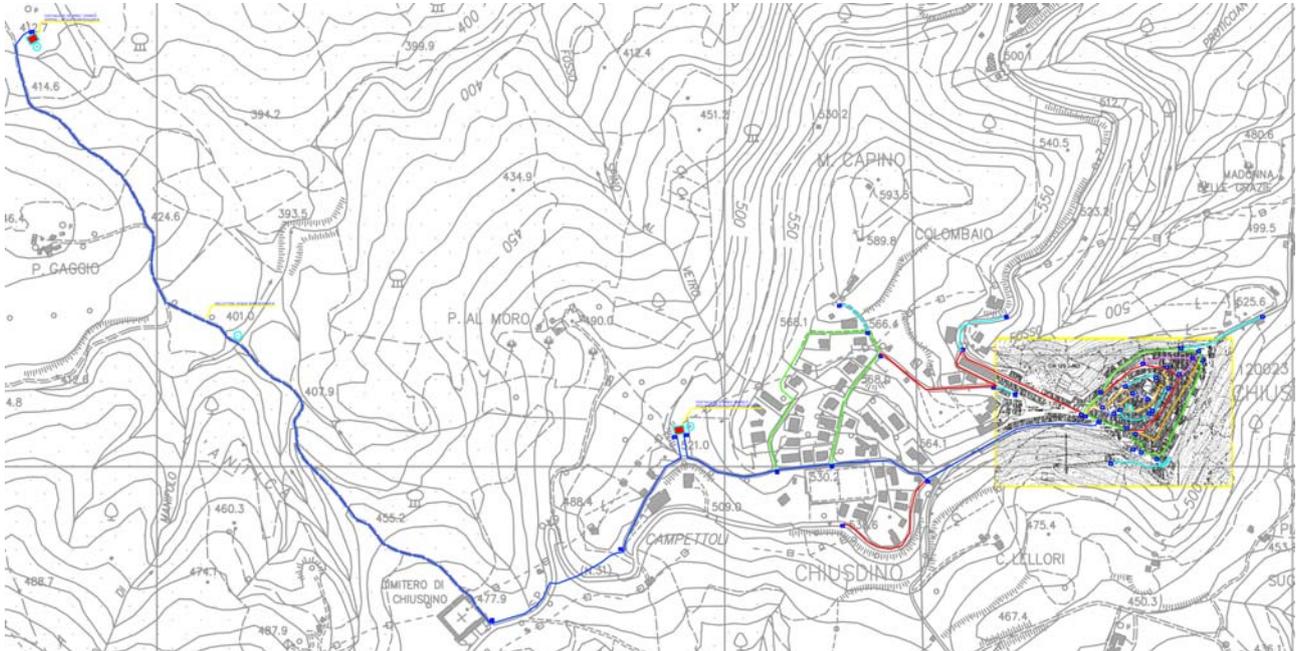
Sviluppo planimetrico complessivo della rete di teleriscaldamento
